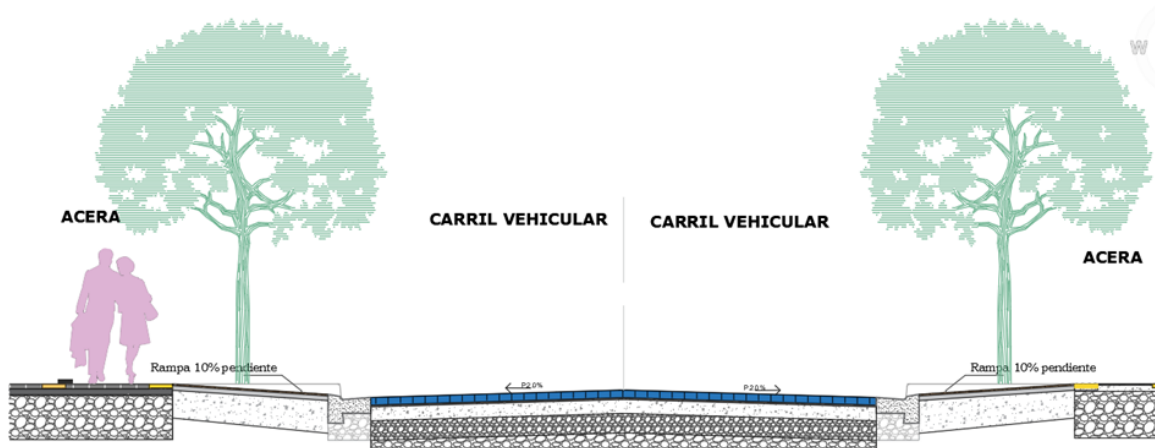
Perfil vial más rampas y accesos. Elaboración Propia
